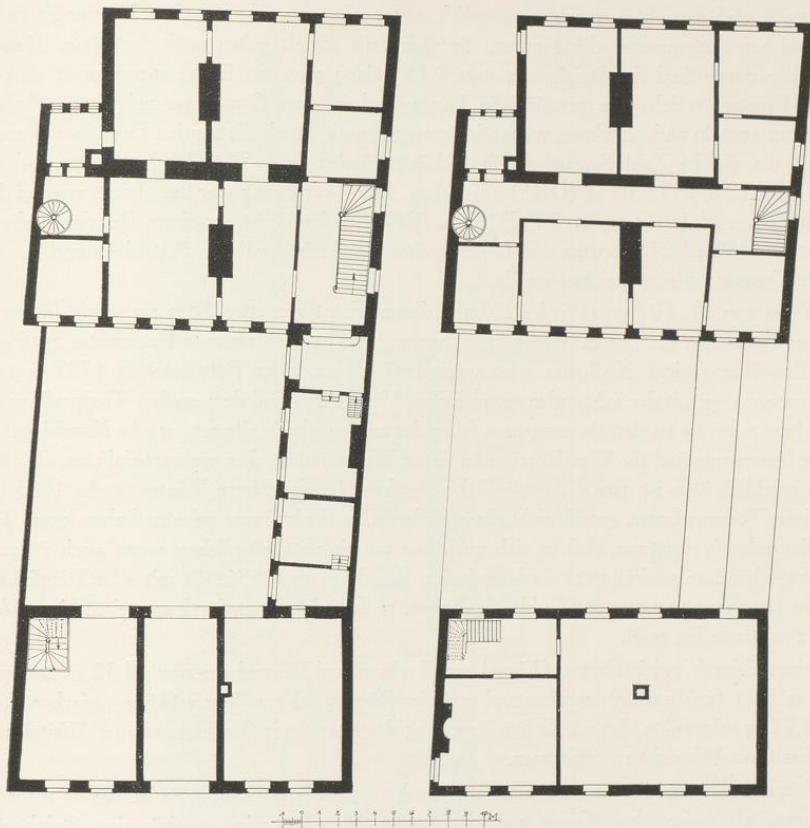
u. 1287. Grundrisse des Erd- und Obergeschosses des Herrenhauses und des Vorhauses des Korffschen Hofes, Alter Steinweg 17/18. Maßstab 1 : 300. Norden oben links
